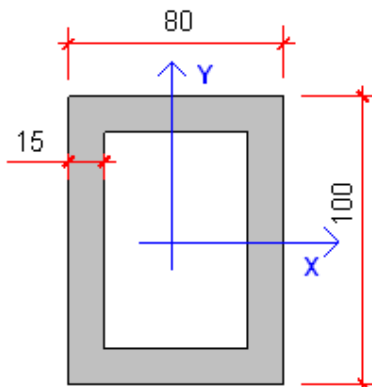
Esquema da seção transversal do pilar (para a opção 1), dimensões em centímetros.
